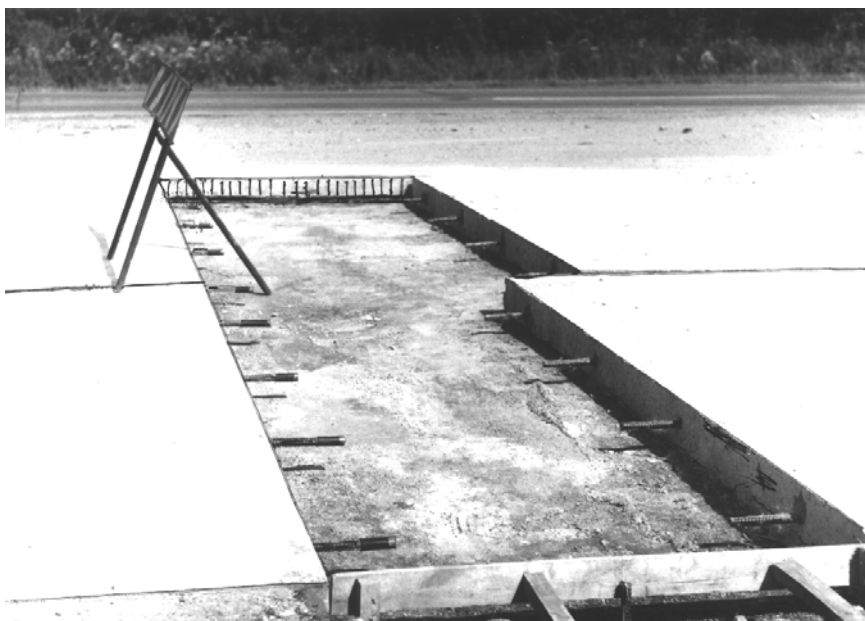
Установка штырей в цементнобетонном покрытии
